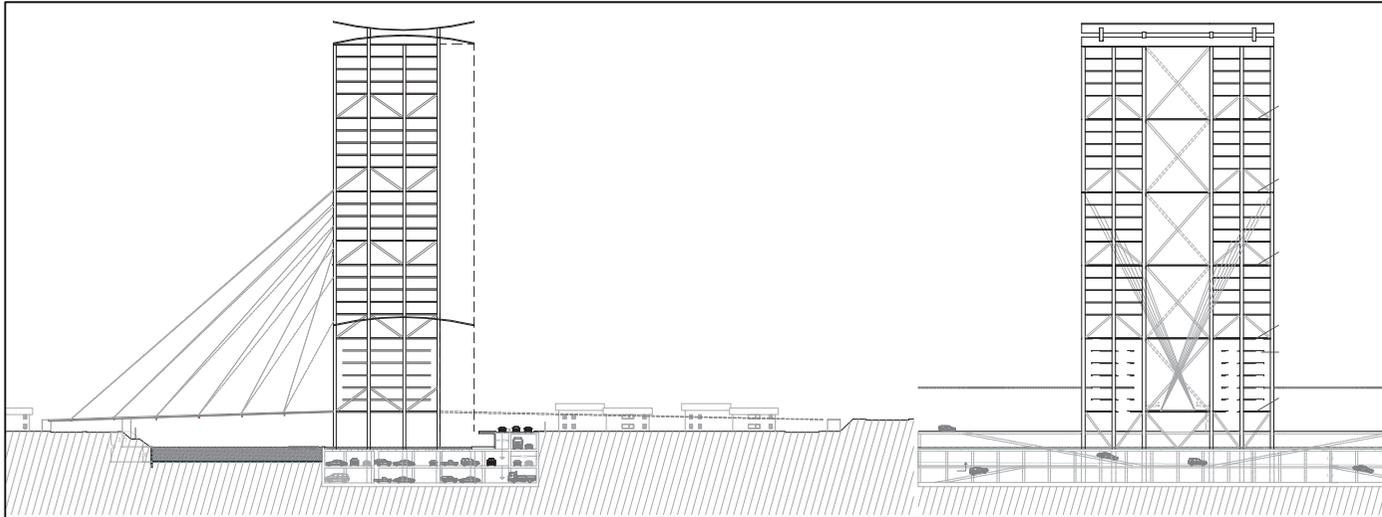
Planos Homero Latorre. Corte lateral edificio pórtico y su emplazamiento en la rivera sur del estero Marga – marga. Se muestra trazado de las pasarelas atirantadas que cruzan transversalmente y unen los barrios de Miraflores (norte) y Chorrillos (sur).
